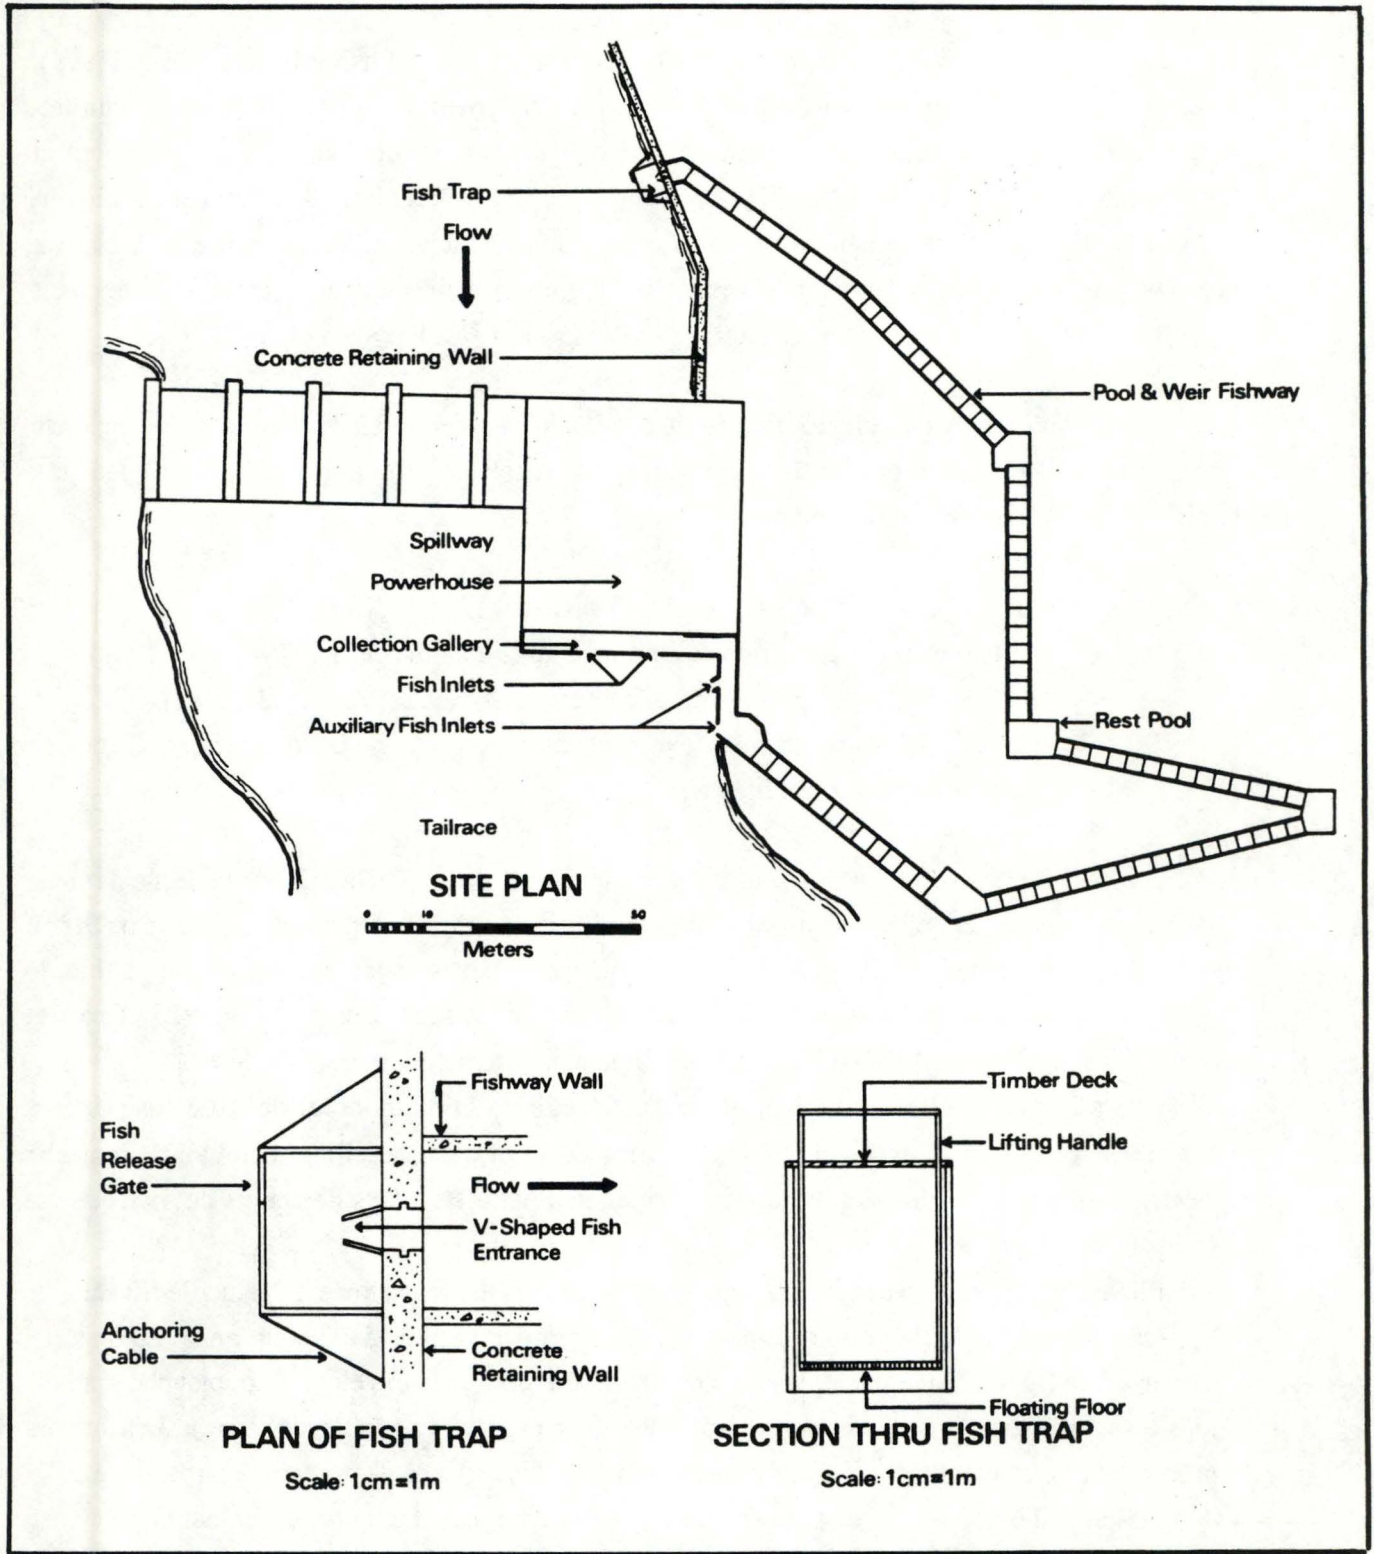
Plan reprenant l'emplacement d'un barrage, d'une passe à poissons et d'une trappe sur la rivière Tobique (Canada). Des détails de la trappe sont mentionnés. - ( Ruggles 1974 )
